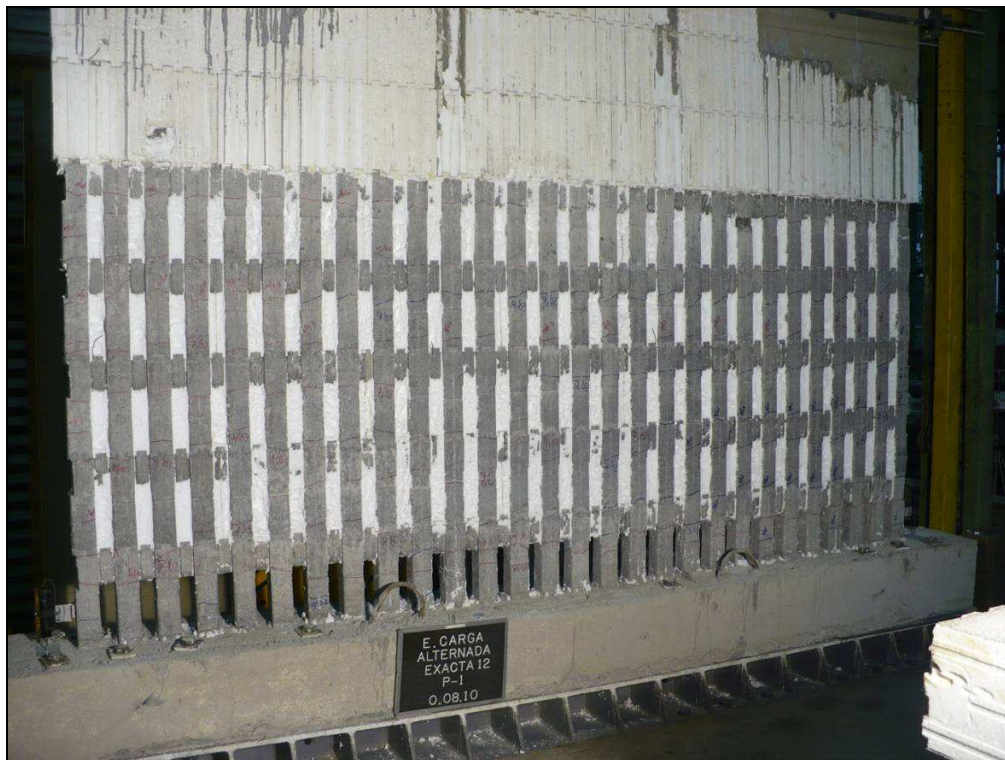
Nivel de daños del muro 1 para el estado límite "*Carga máxima*".
